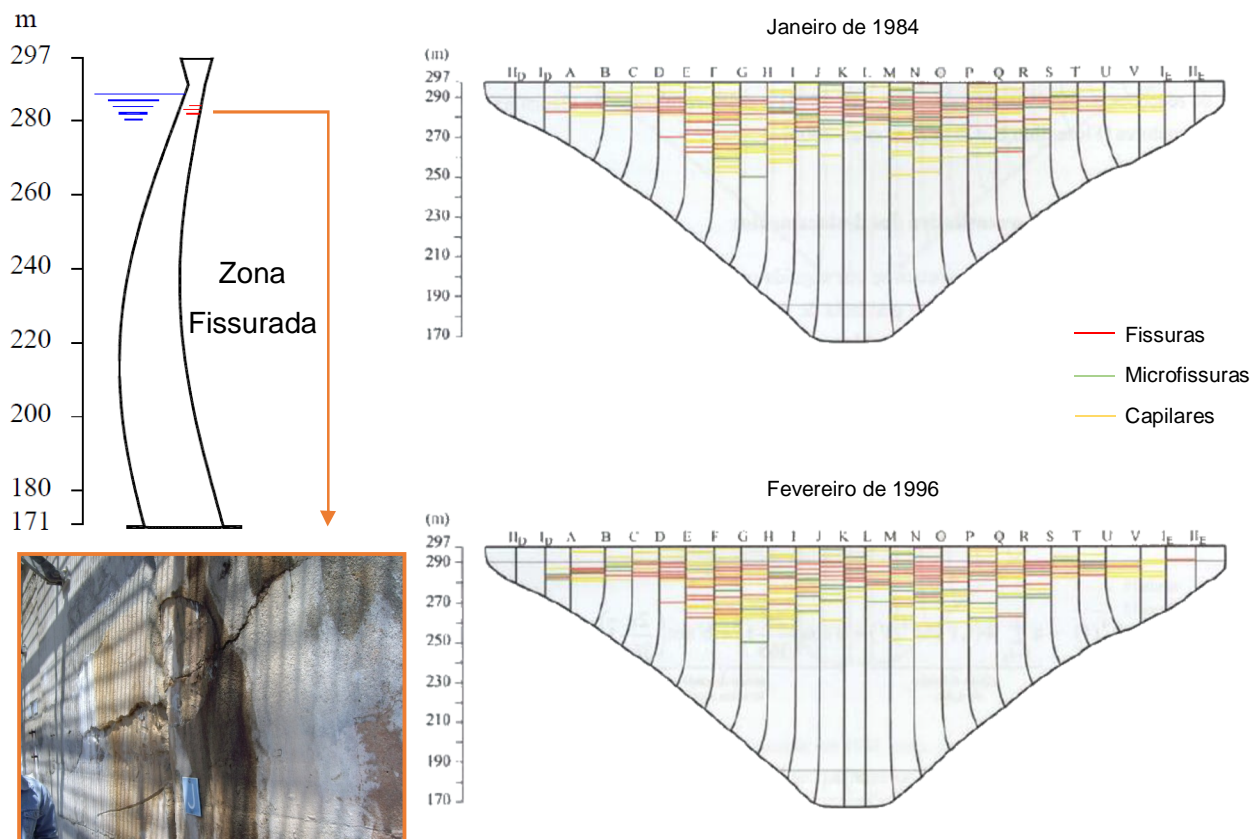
Fissuração no paramento de jusante na barragem do Cabril. Evolução após os trabalhos de reabilitação (adaptado de (Oliveira S. , 2000); (Oliveira, Espada, & Silvestre, 2016)).
